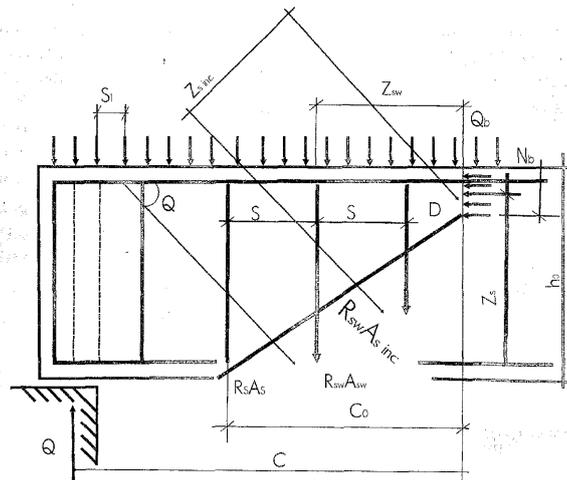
К расчету изгибаемого элемента по наклонному сечению
